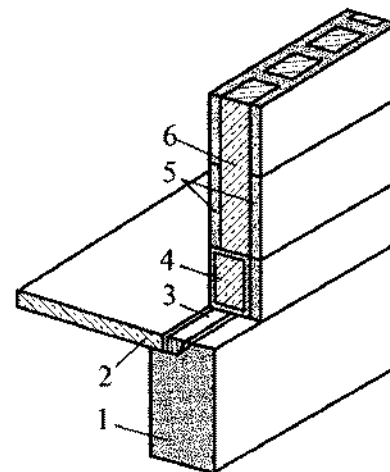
Сопряжение перекрытия с надстраиваемой стеной:
